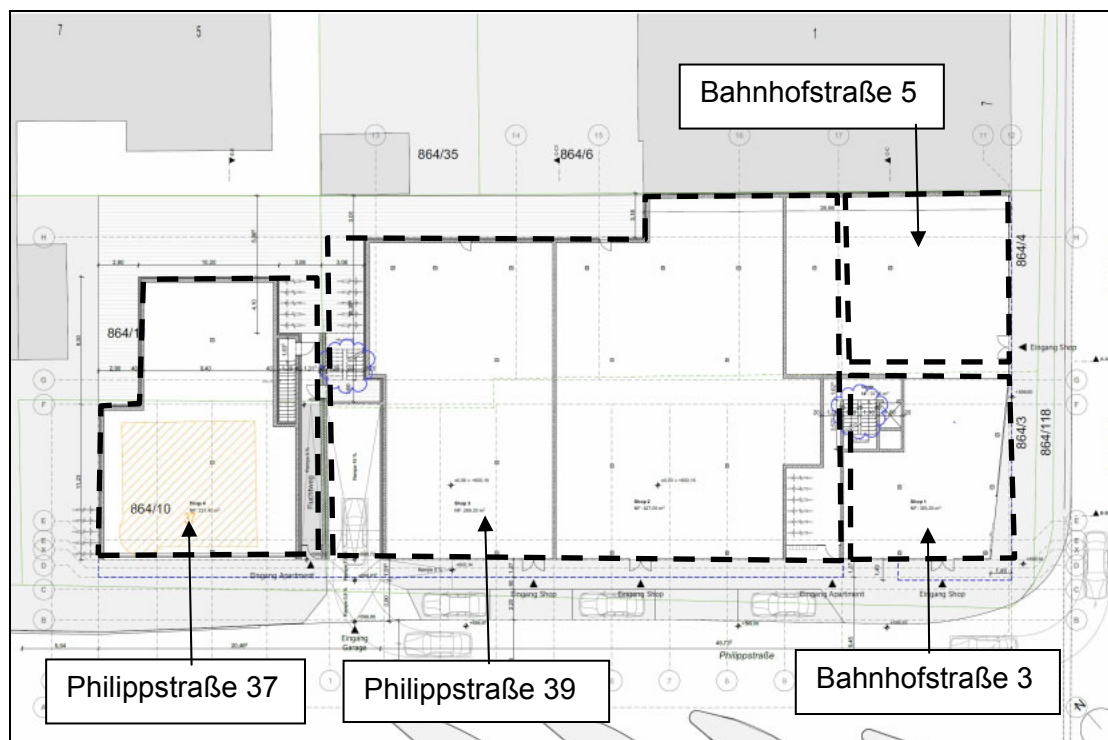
Grundriss Erdgeschoss der Planung [c]
